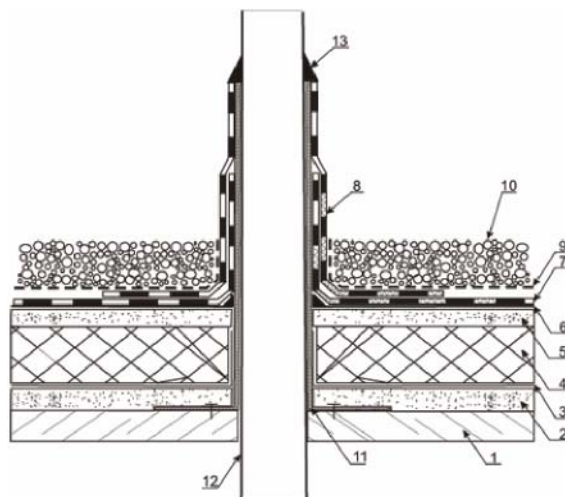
Примыкание к трубе для традиционной кровельной системы (Неэксплуатируемая кровля).
